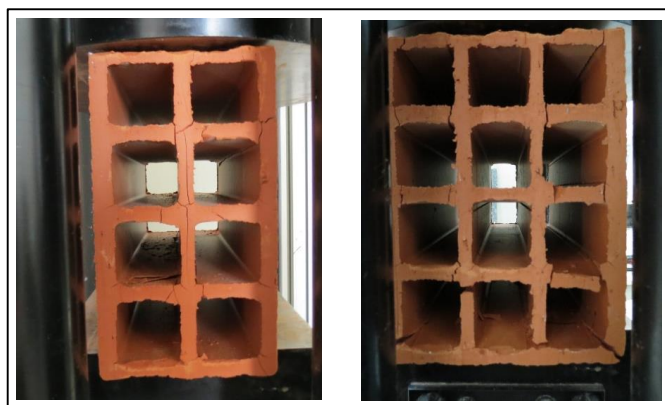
Rotura dos tijolos por fissuração dos septos
